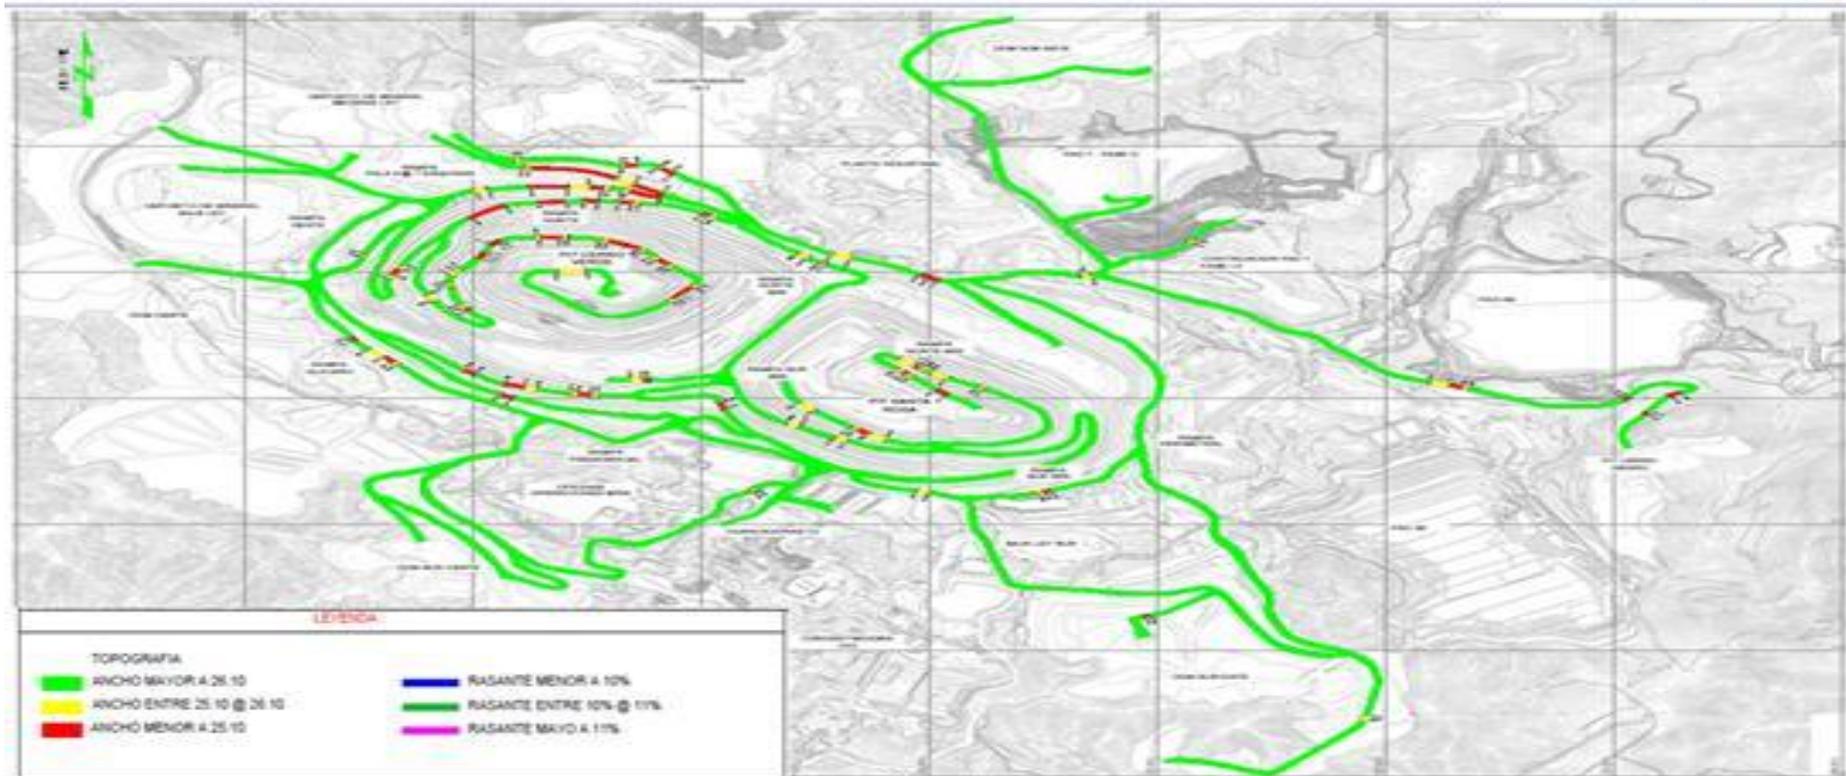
Plan de trabajo de anchos de vías de acarreo Fuente Cerro Verde
